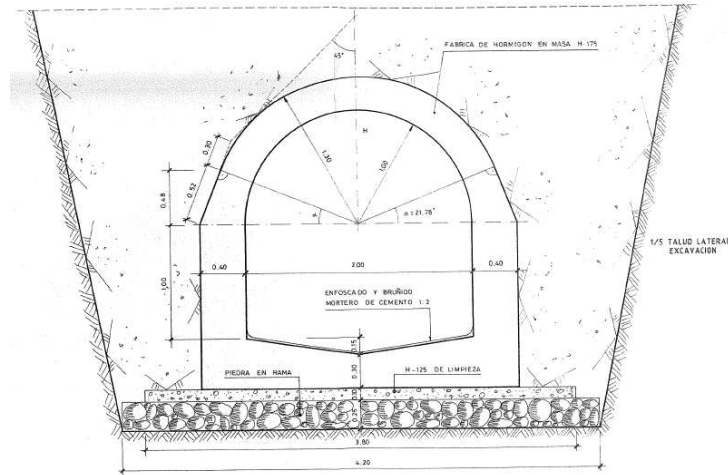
Extracto del Plano de sección tipo del Proyecto de Canalización Barranco Foietes, en Benidorm
